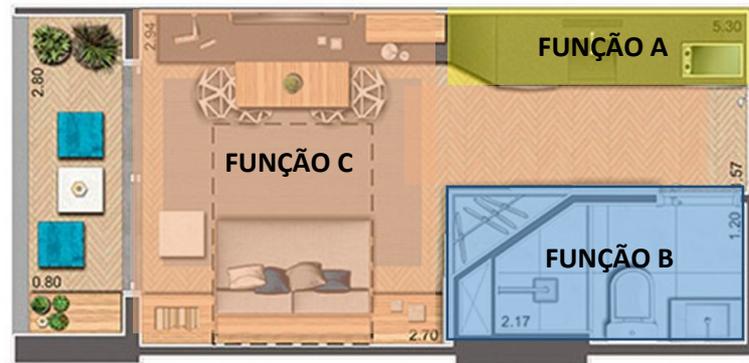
Planta Baixa 18m<sup>2</sup> - Setin Downtown São Luis
